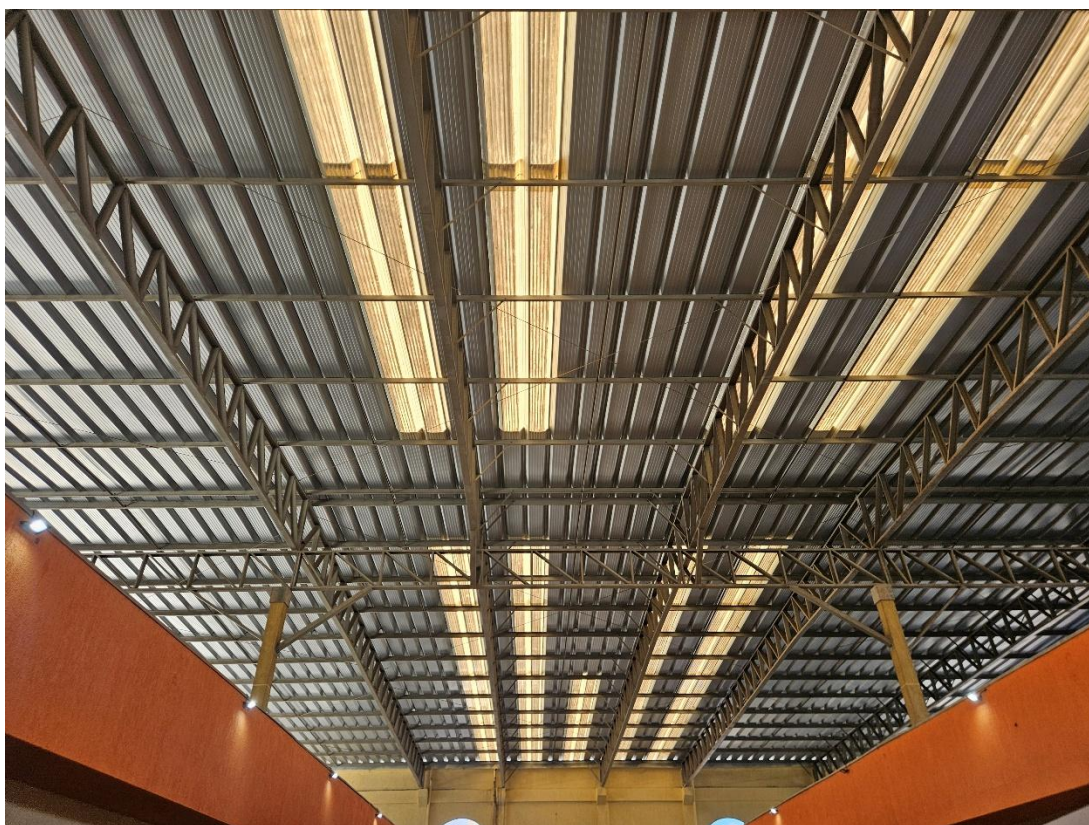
Estrutura Metálica do Telhado do CEM Ghislandi
